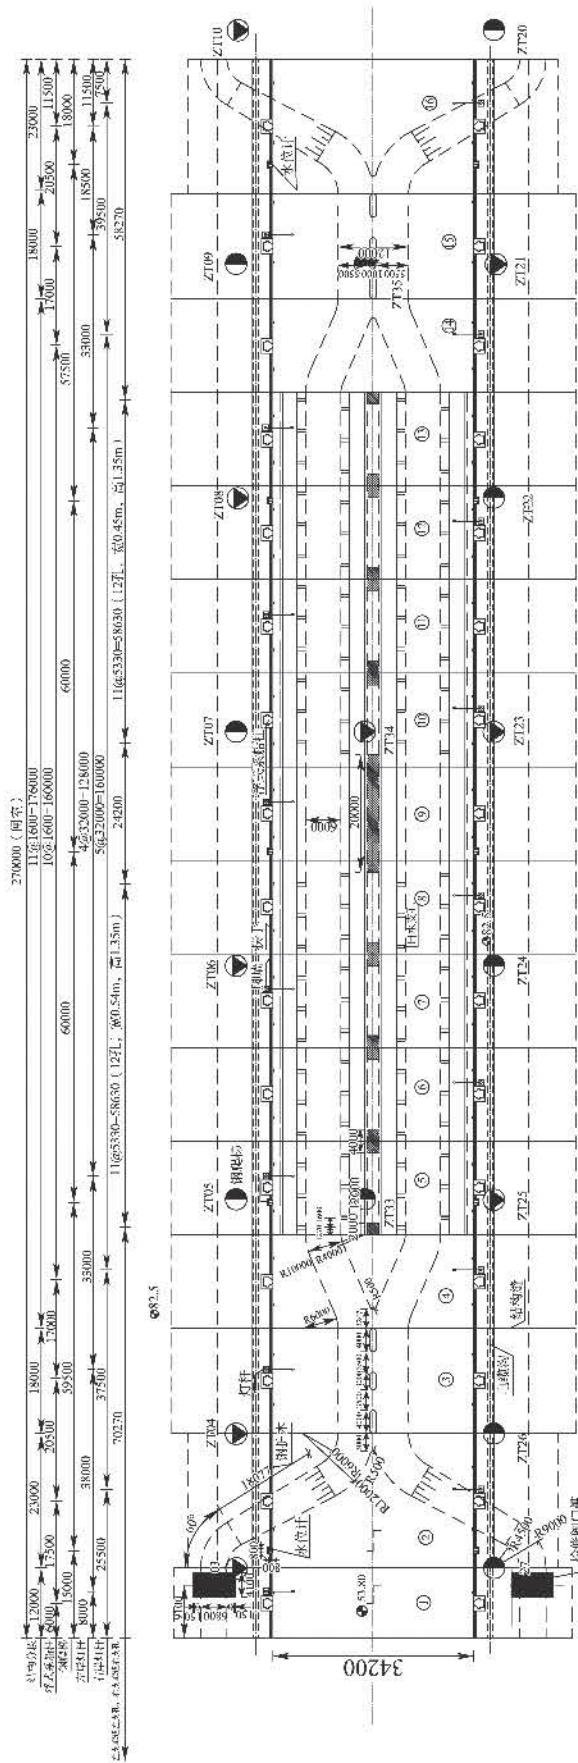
通航建筑物工程-西江水系柳江某船闸工程-闸室平面示意图(尺寸单位:mm;高程单位:m)
